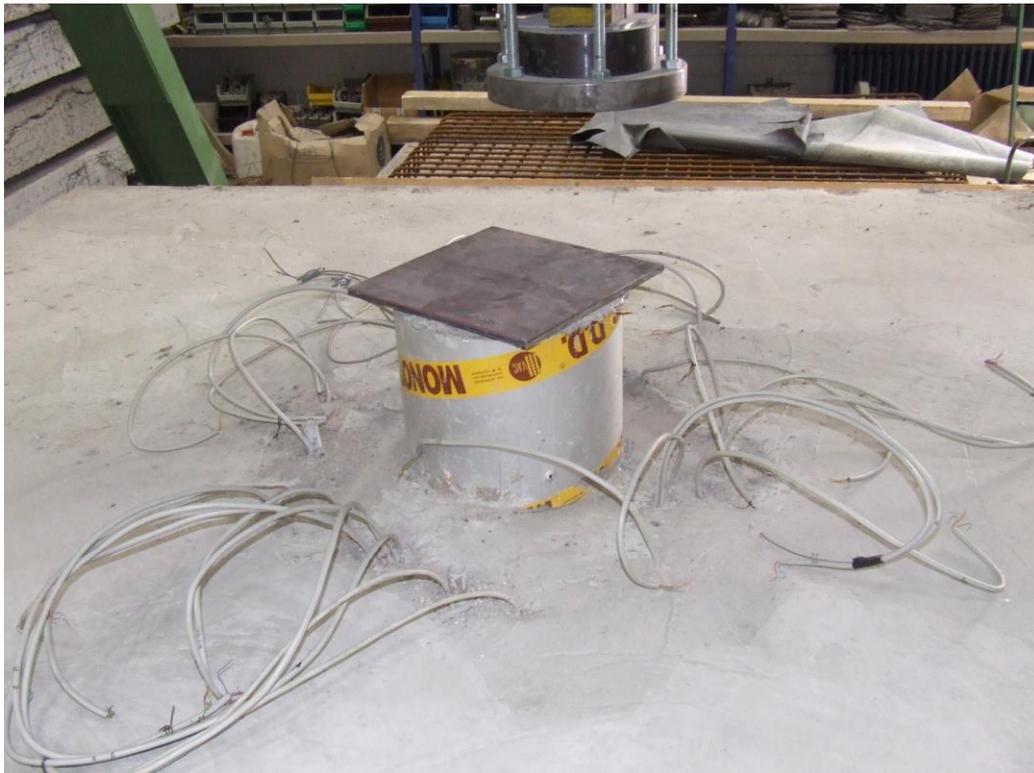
Draufsicht nach dem Betonieren – Versuchskörper ED
